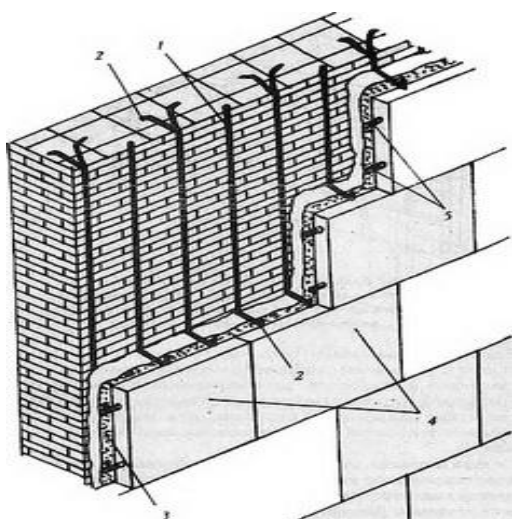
29. Кріплення плит за допомогою стержнів, петель і штирів: 1 – опорний стержень; 2 – петлі (ковзний варіант); 3 – розчин; 4 – плити облицювання; 5 – штирі
